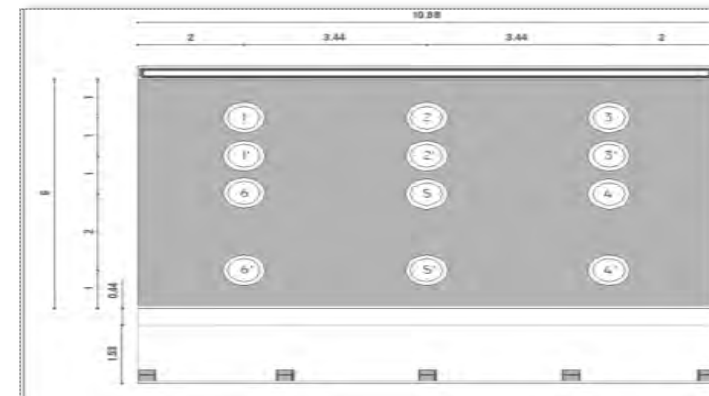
Ubicación de dispositivos en maqueta de evaluación.
